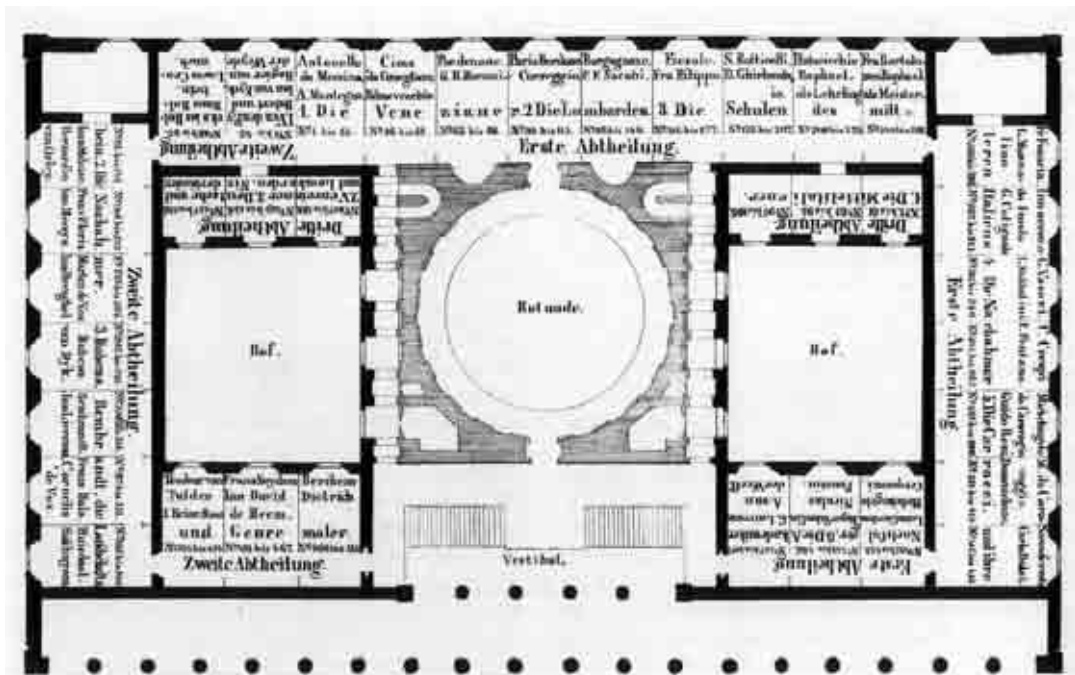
(#178) Grundriss des Königlichen Museums in Berlin, 1830. (Foto: TW)
